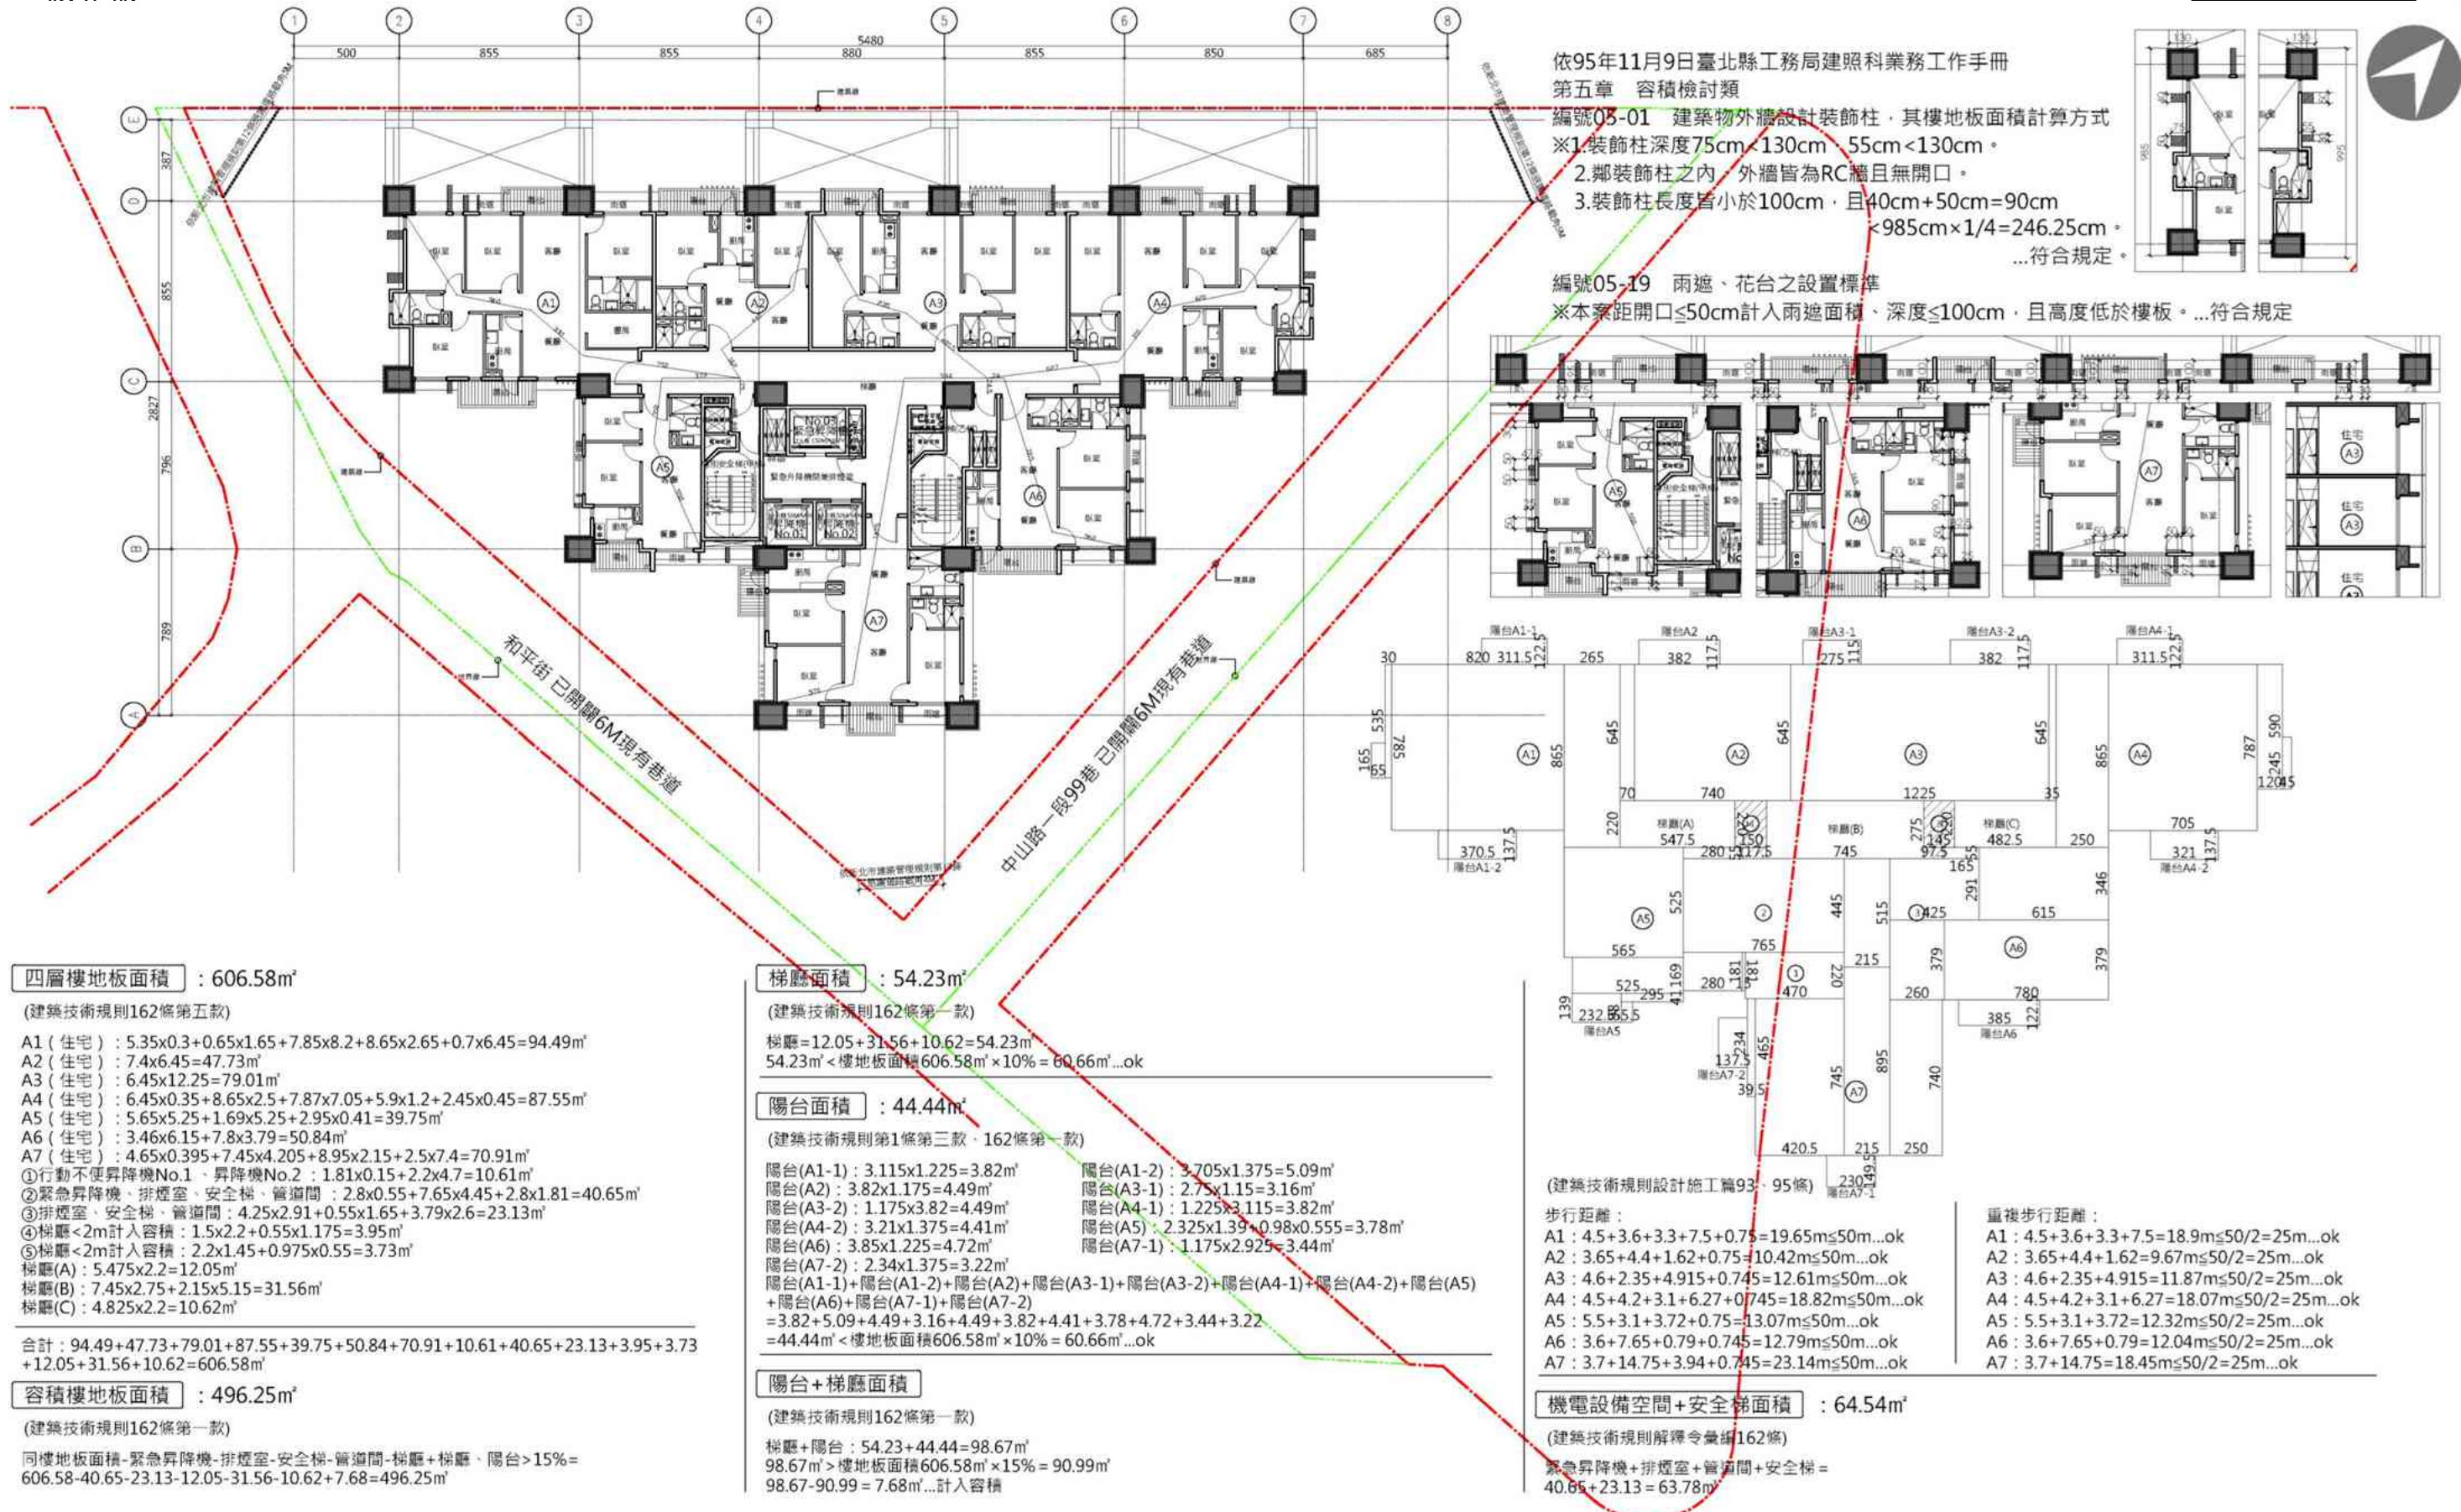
4F 平面圖；SCALE A3=1/300
